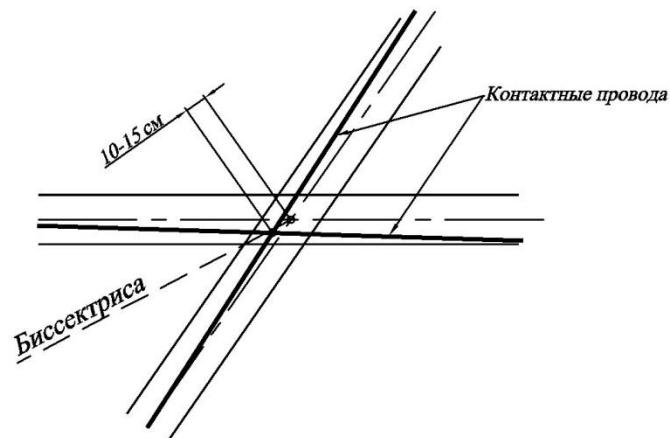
Схема размещения воздушной крестовины на пересечении трамвайных путей
